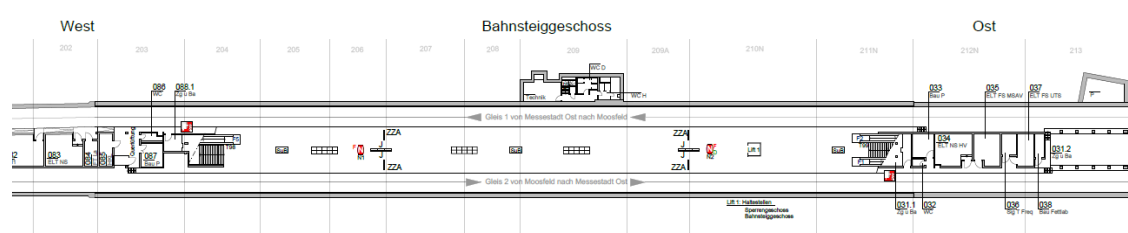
Grundriss Bahnsteig ME
